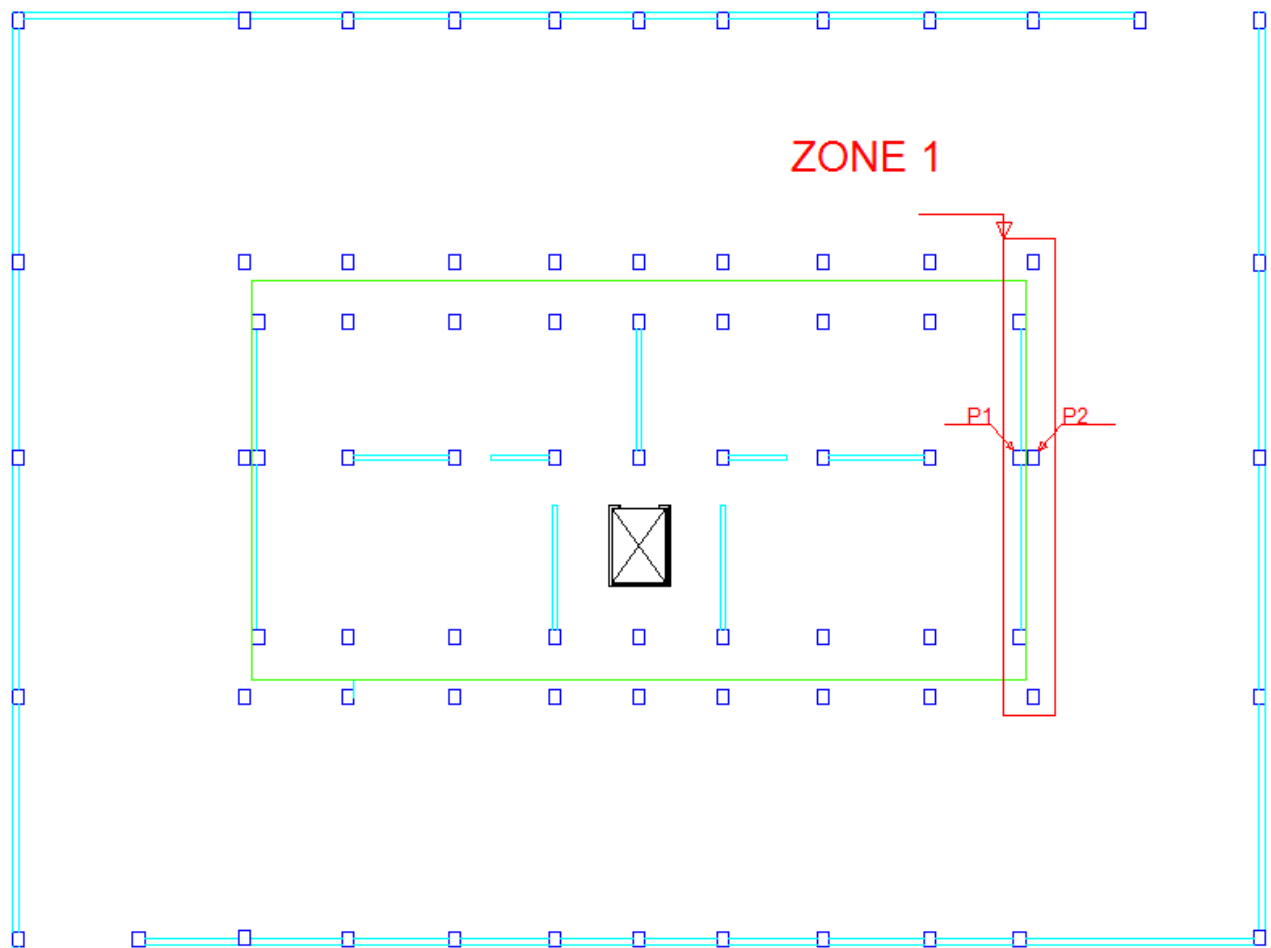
SCHEMA DE LA DISPOSITION DES POTEAUX ET DES VOILES DU SOUS-SOL
